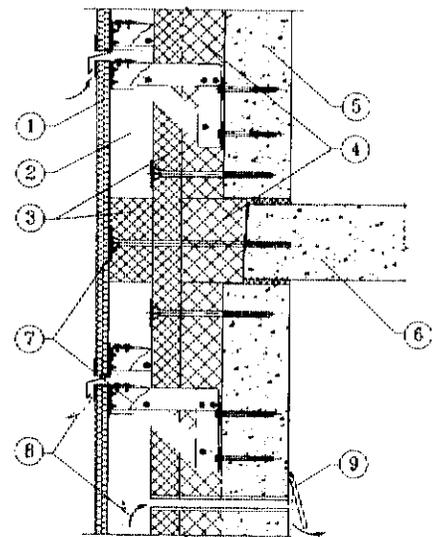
Конструкция наружных стен с вентиляционными устройствами
